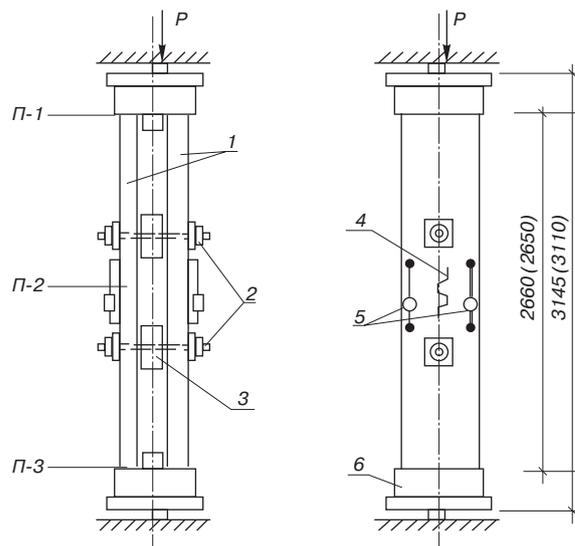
Схема испытания стоек-колонн на сжатие: 1 – линейный элемент; 2 – соединительные болты; 3 – прокладки; 4 – датчики; 5 – индикаторы; 6 – оголовок; П-1, П-2 и П-3 – прогибомеры
